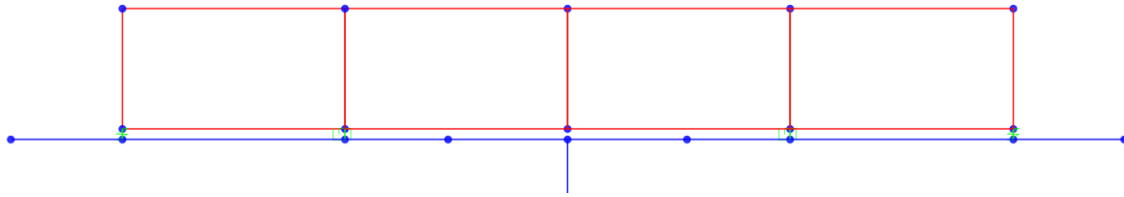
Conexión pila-tablero con los neoprenos (exteriores) y disipadores (interiores)
